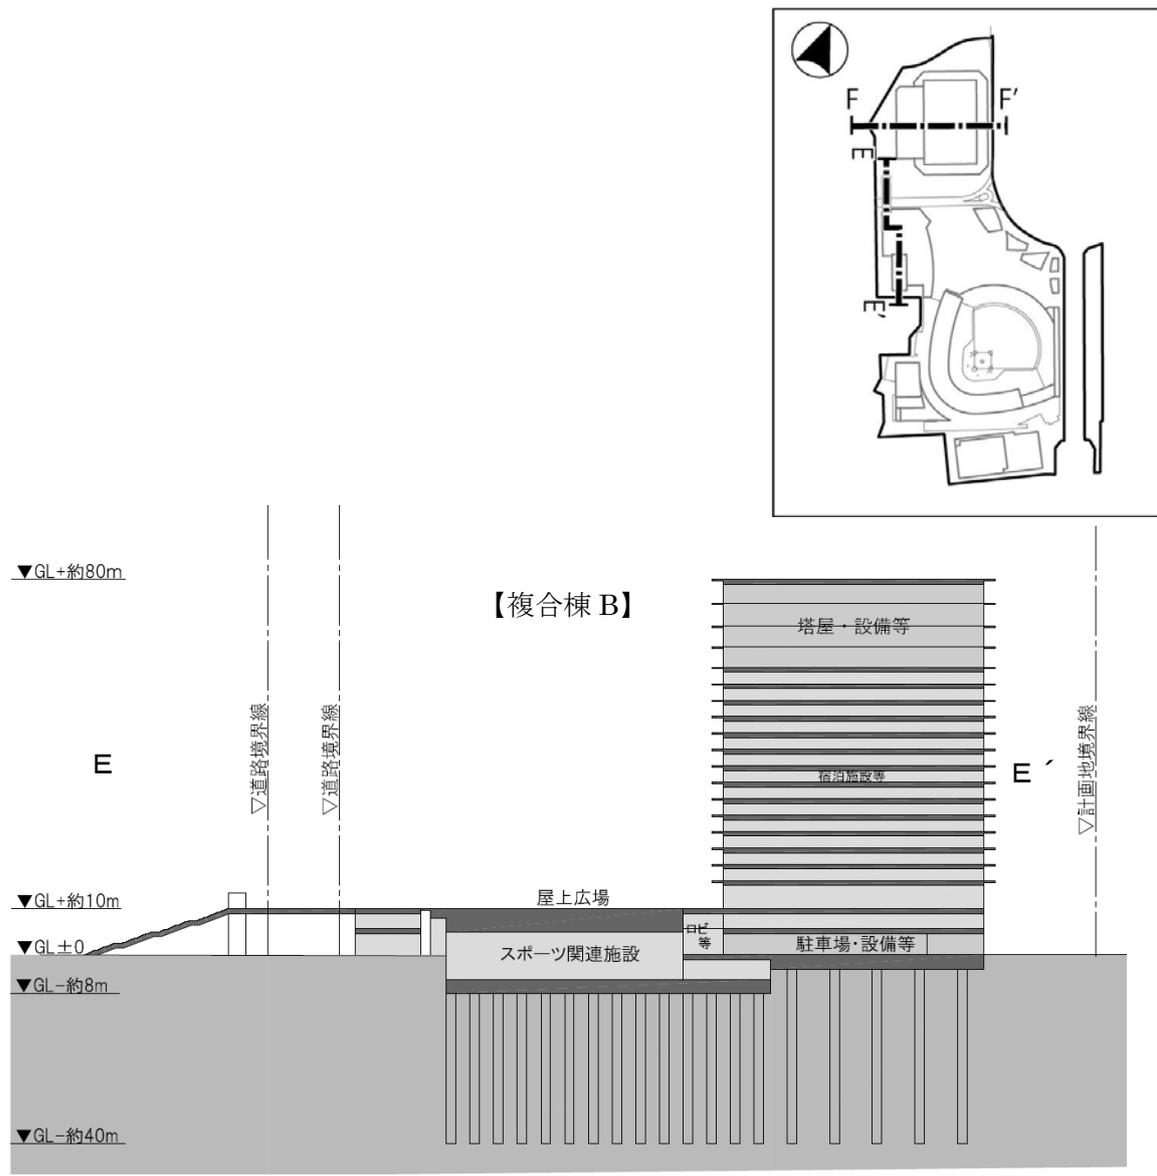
2-4 (3) 断面図 (E-E' ) S=1/1, 600
